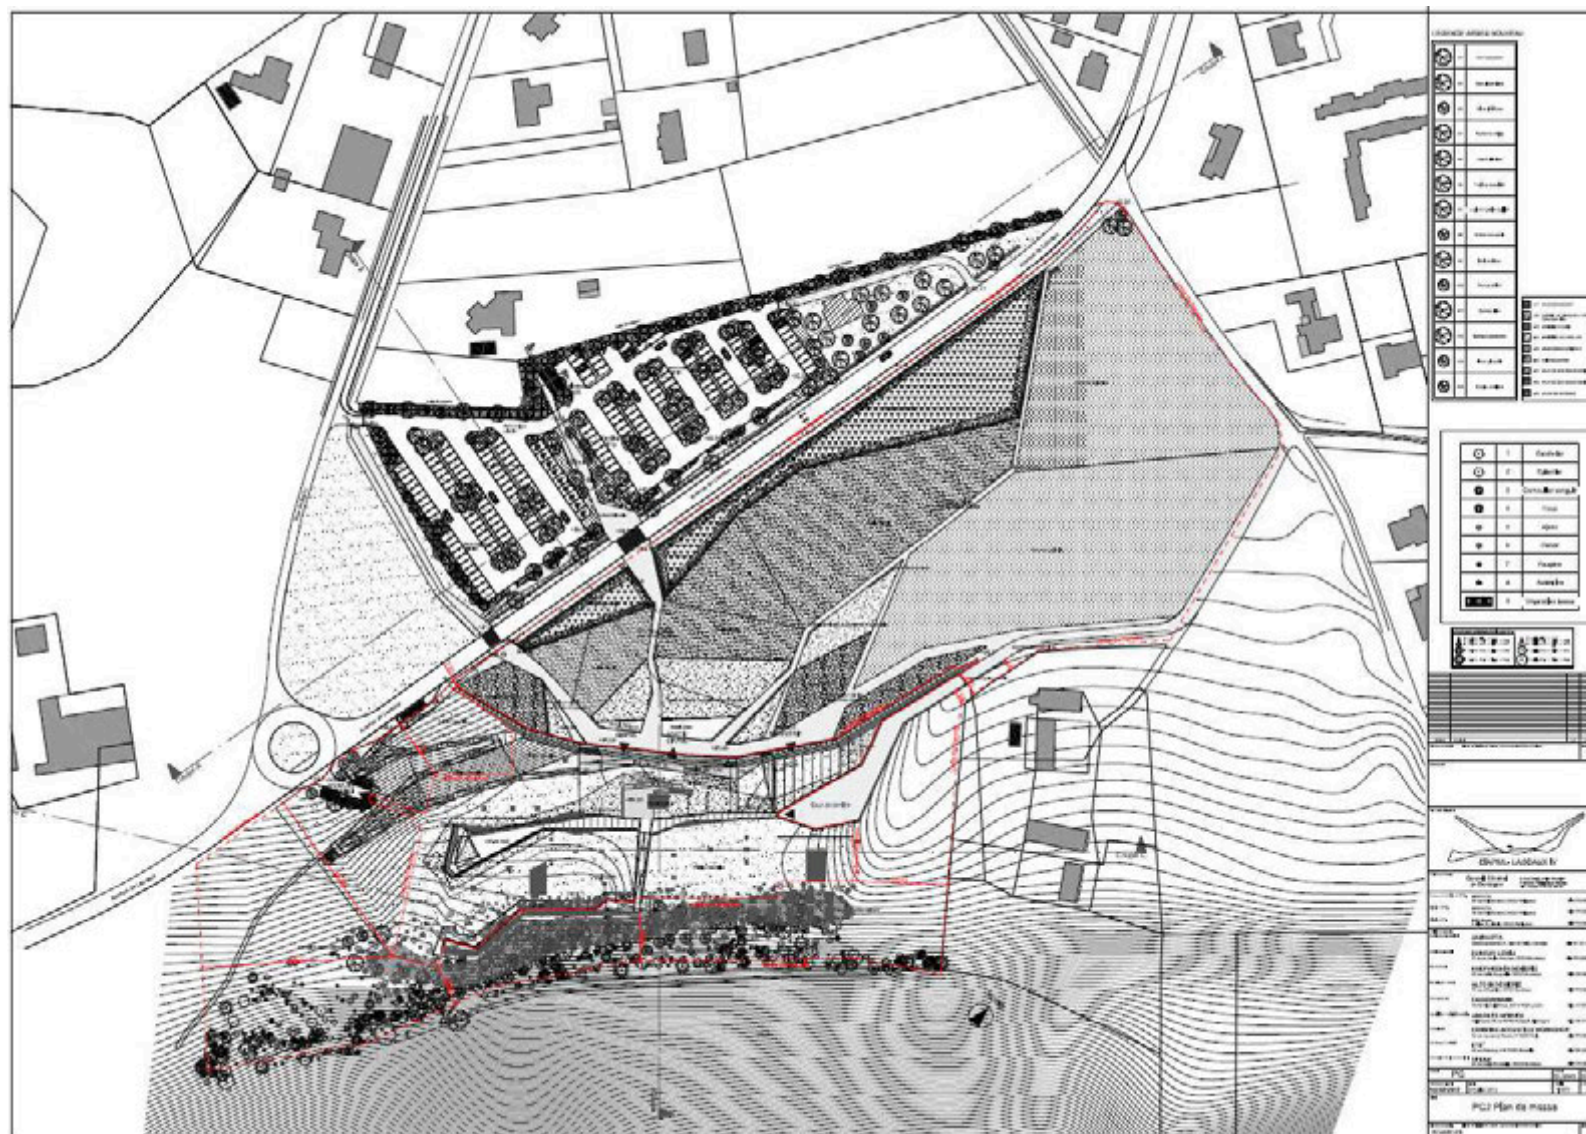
Plan de masse du projet (Source : SNØHETTA)
